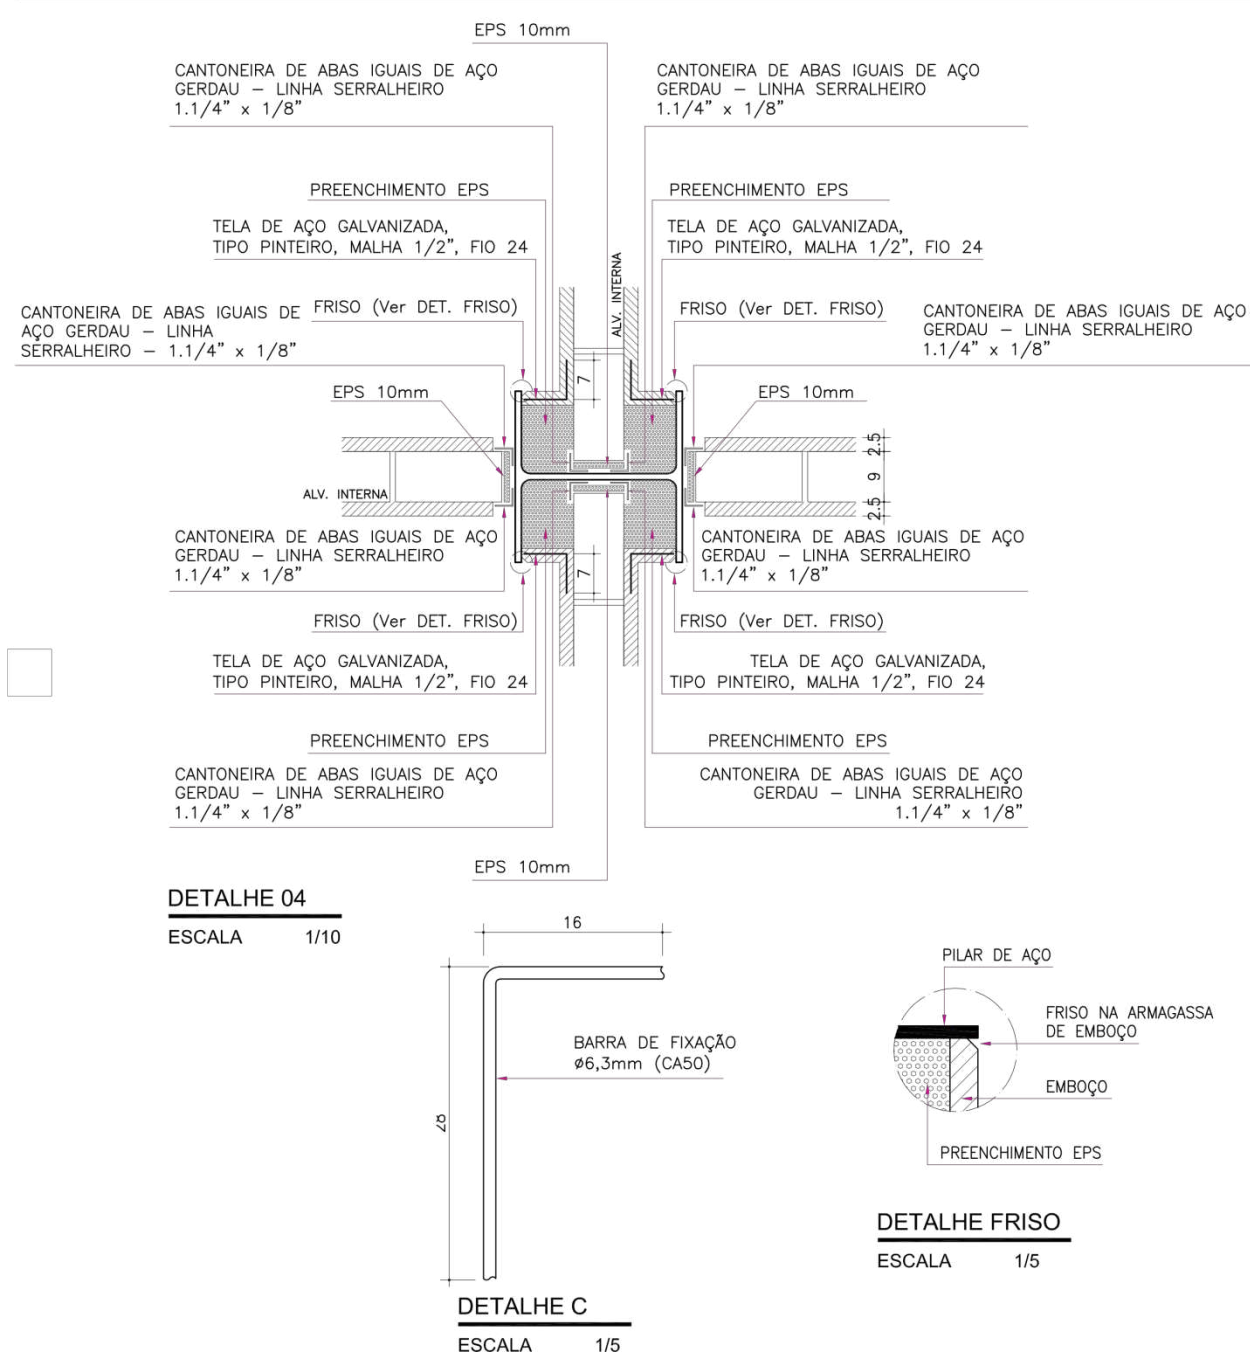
Detalhe do projeto de alvenaria do edifício da obra social da IPV, com preenchimento do espaço vazio entre o pilar e a alvenaria com EPS.
